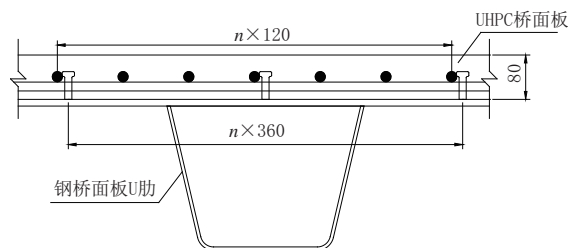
跨中断面 UHPC 桥面板钢筋布置(单位:mm)
